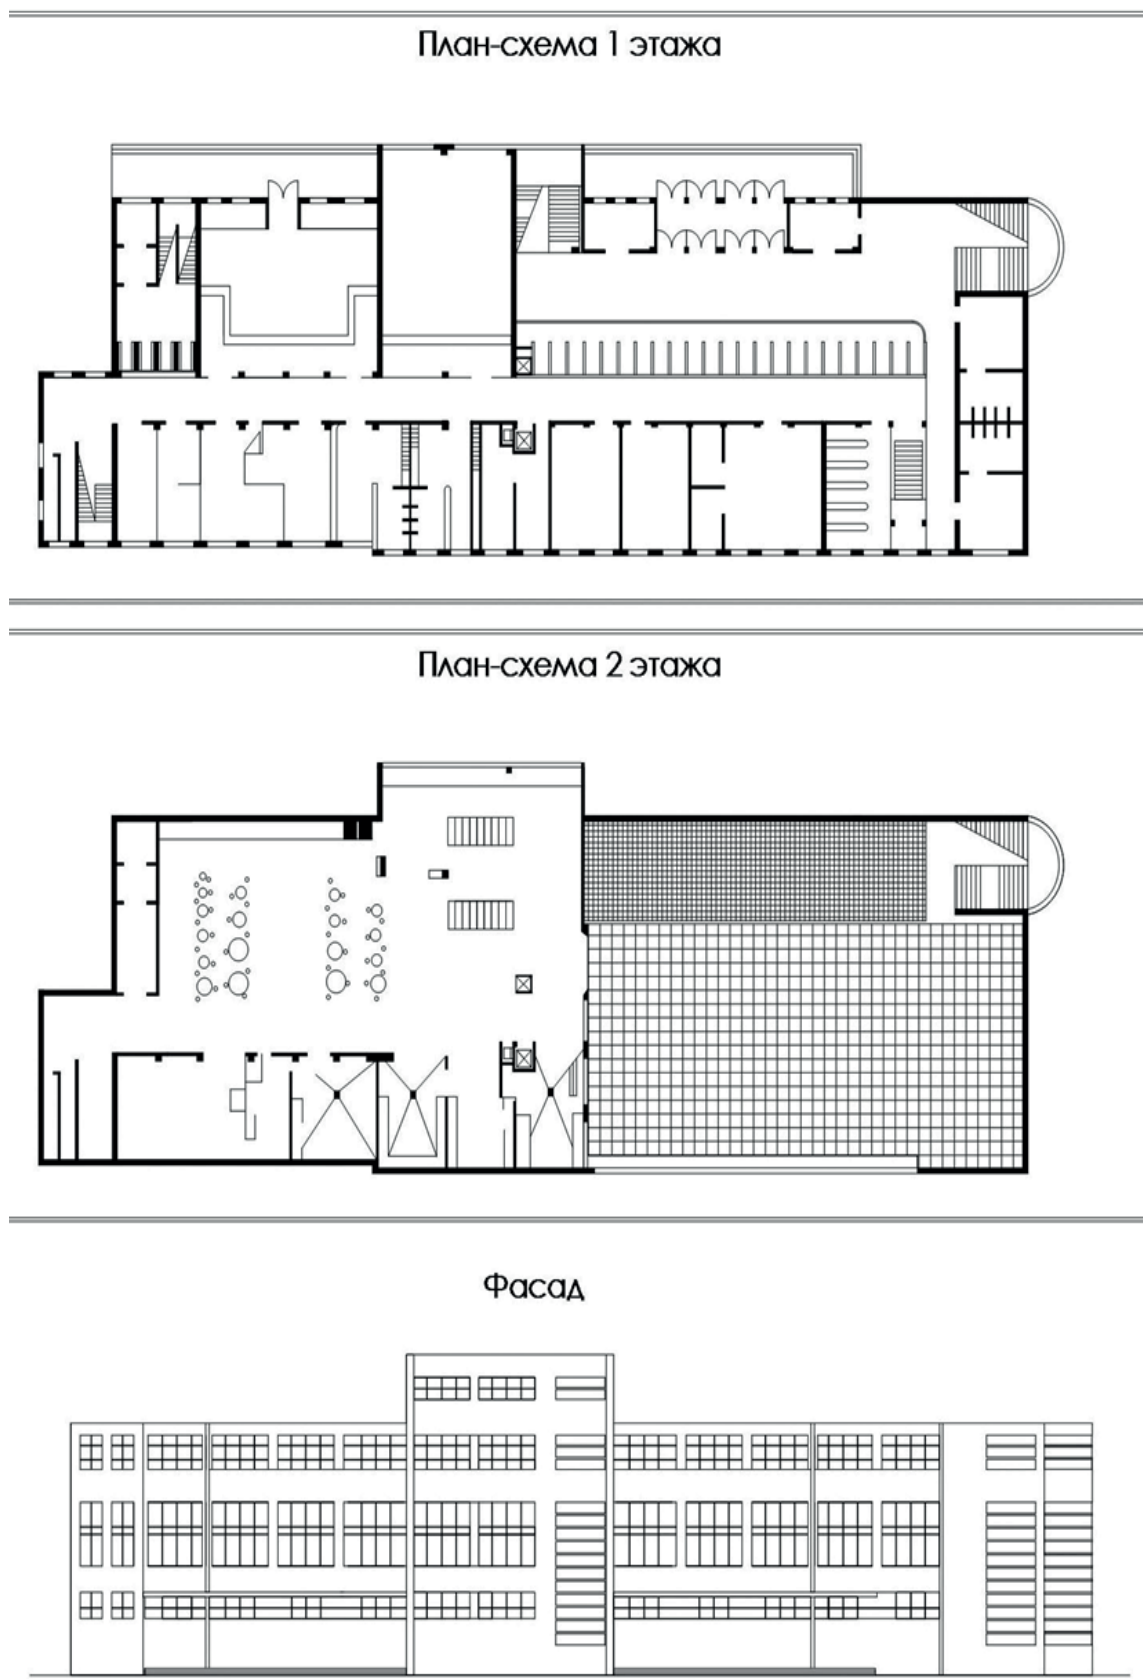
Планы и главный фасад фабрики-кухни в Баку (Баилово). Авторская реконструкция
